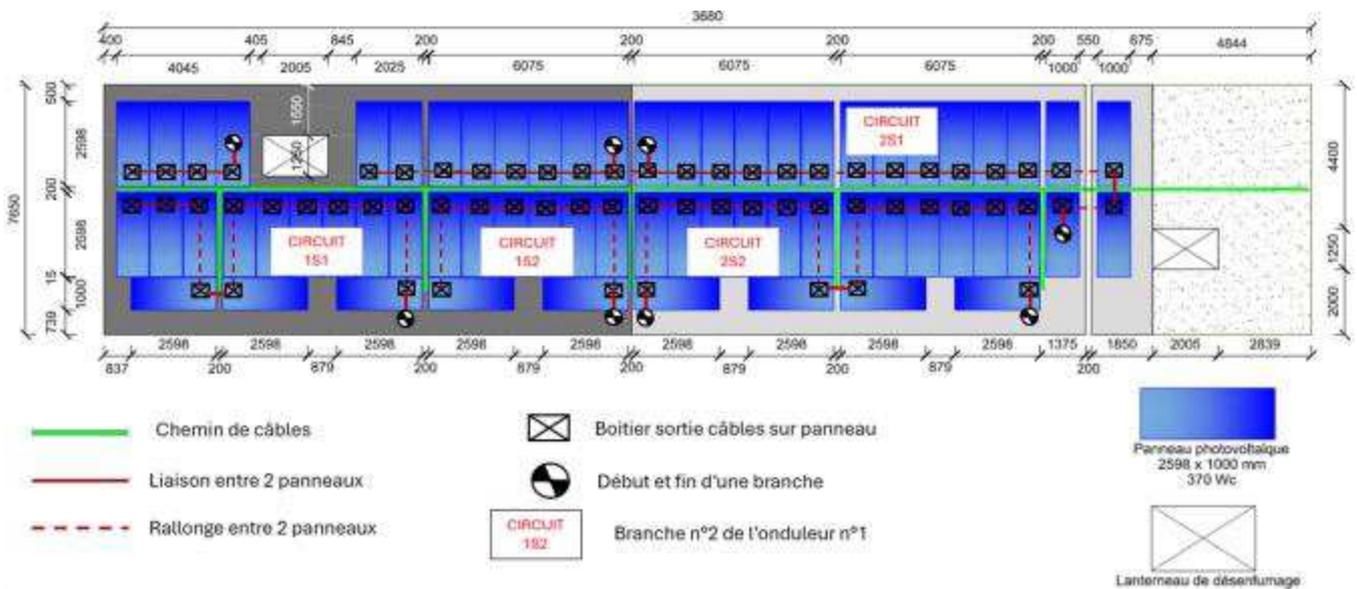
Exemple de plan de raccordement des modules photovoltaïques sur toiture-terrasse
